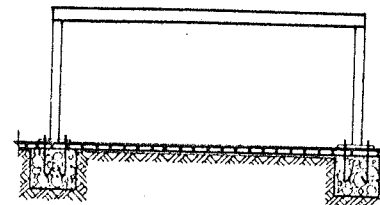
Pórtico mixto: viga de hormigón armado y columnas metálicas.
